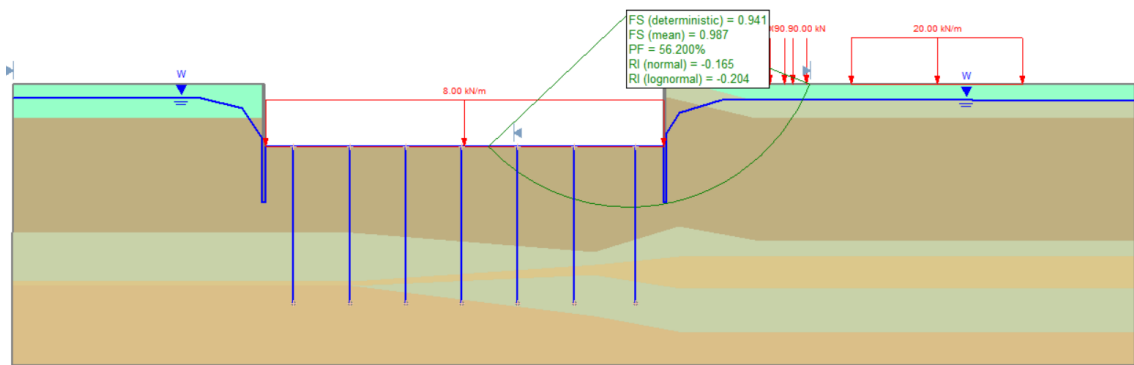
Sección 1, carga 8 kN/m, ancho pantalla 0.4 m, profundidad pantalla 17 m.
